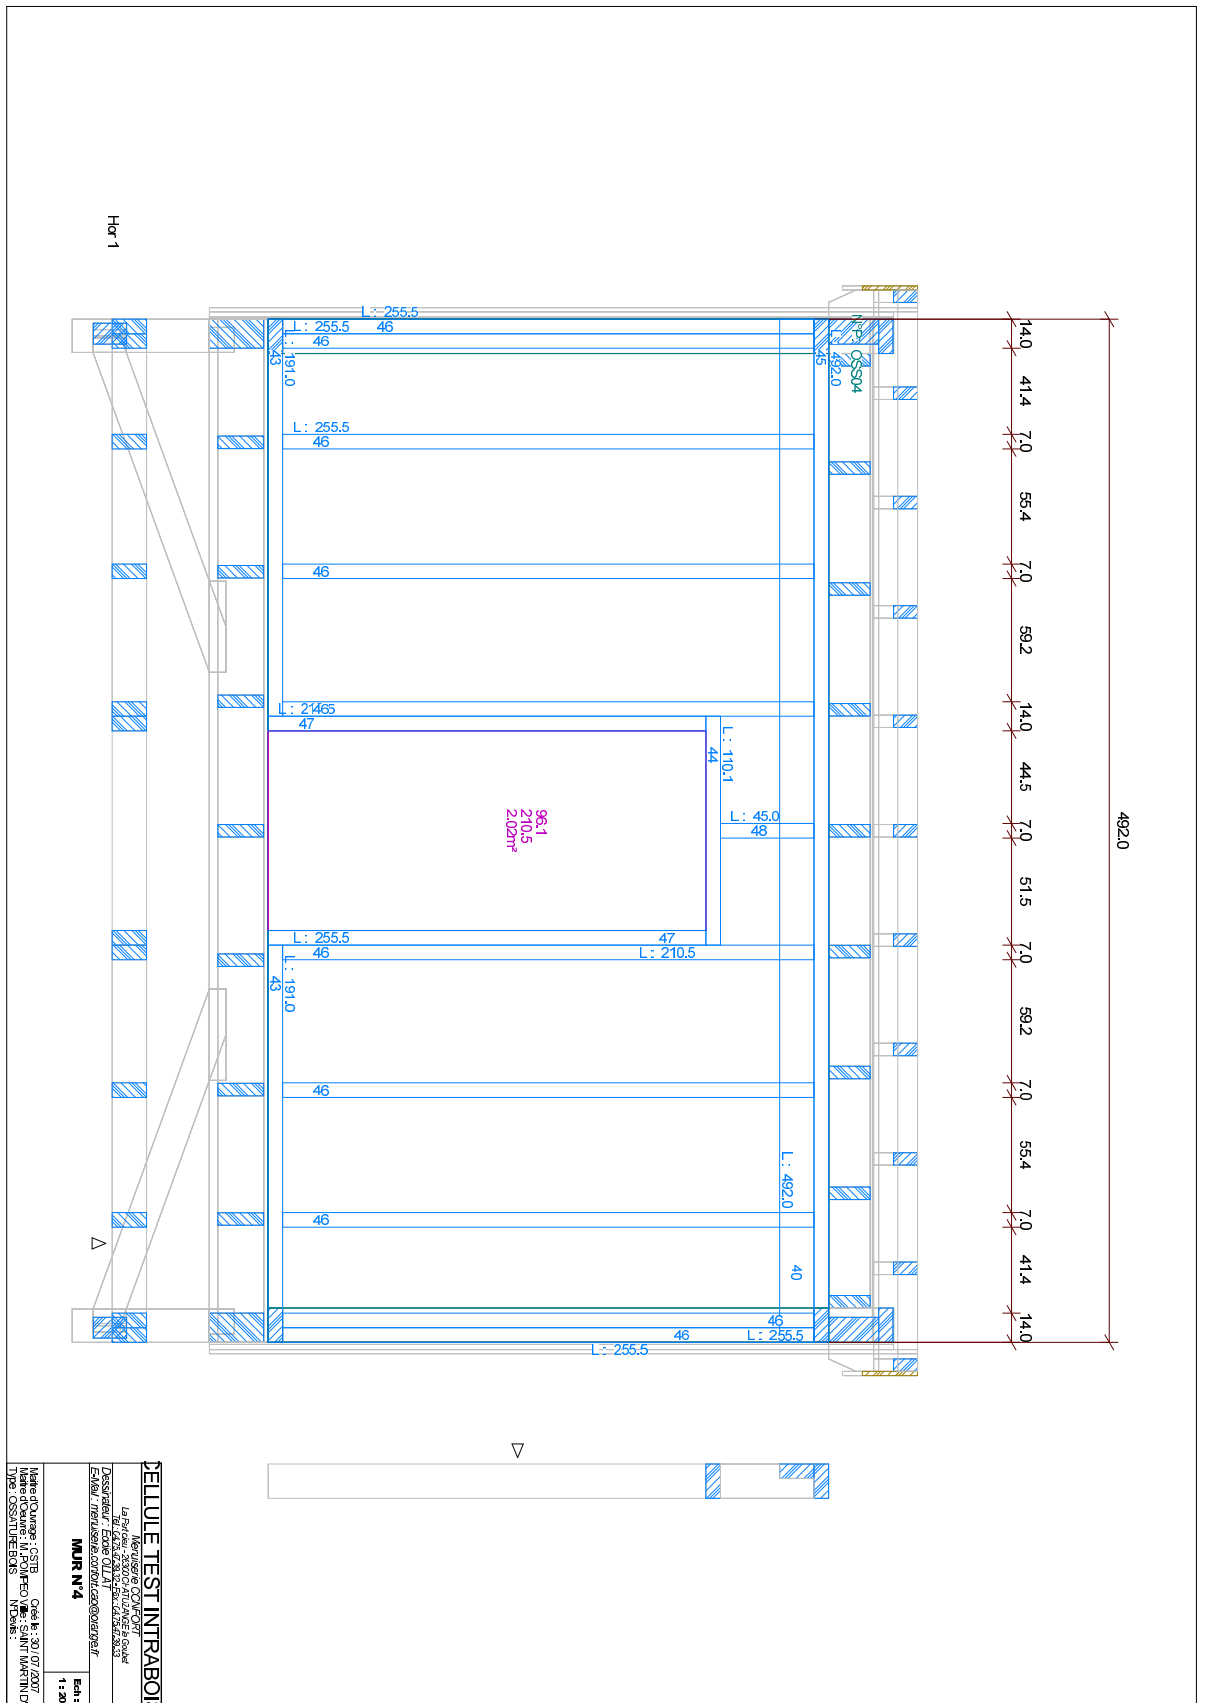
Vue en coupe verticale de l'ossature de la cellule, mur de façade Nord
